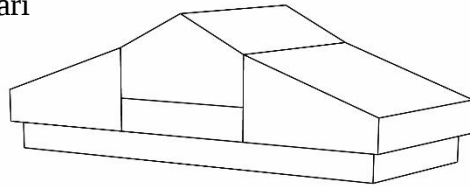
4: Konsep massa bangunan gedung DPRD Pidie
